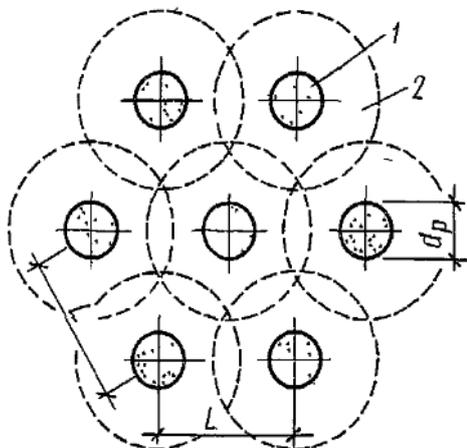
Схема размещения песчаных свай в плане: 1 — песчаная свая; 2 — зона уплотнения
